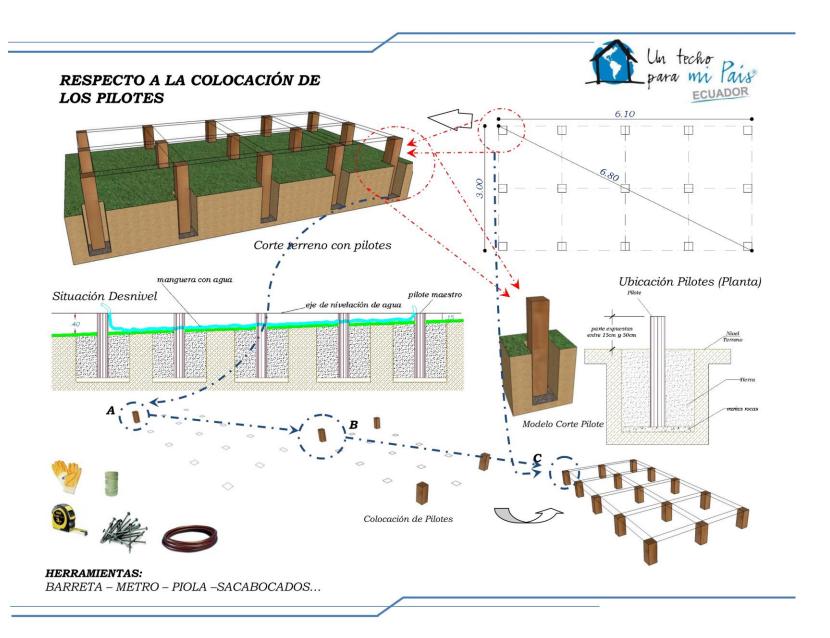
Colocación de pilotes, Fuente: Manual para la construcción - TECHO
